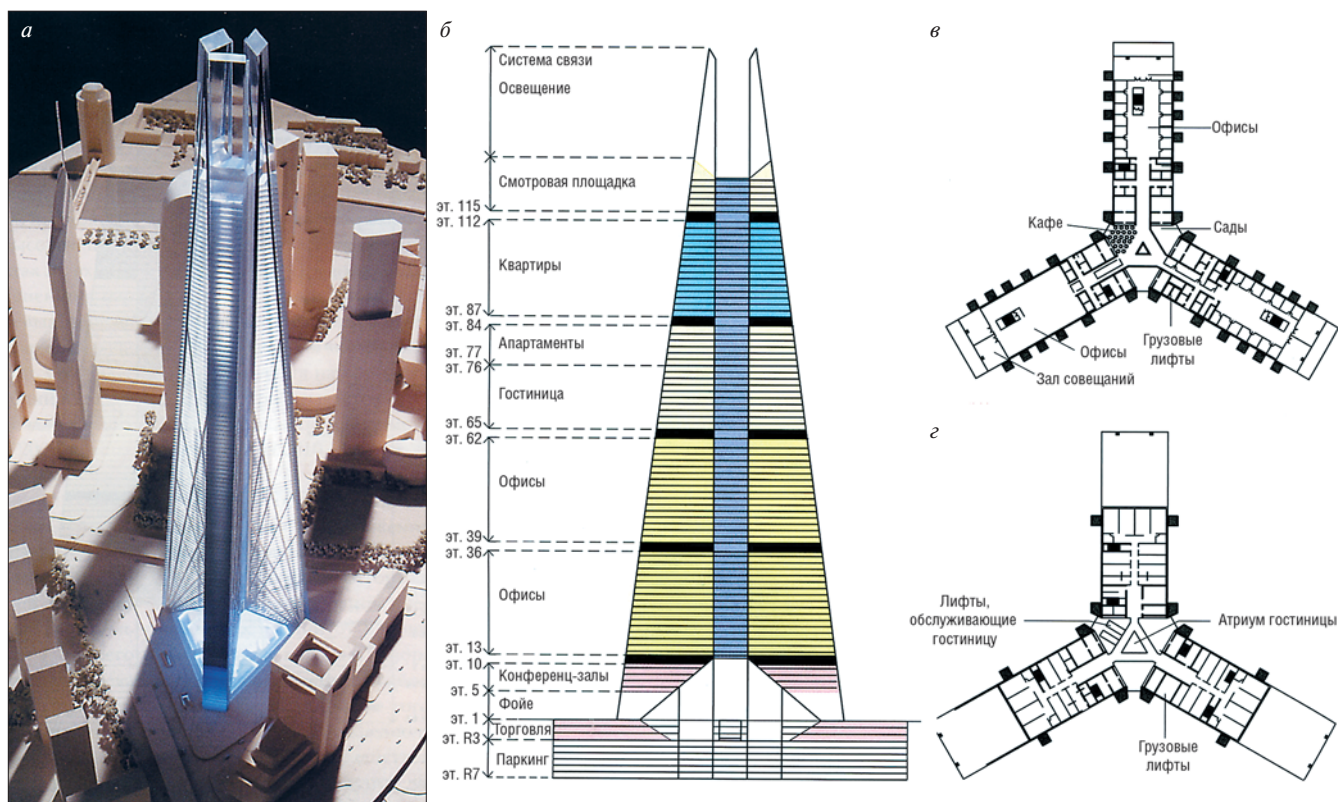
Башня «Россия»: а – общий вид; б – схематический разрез; в – план 30-го этажа; г – план 70-го этажа
